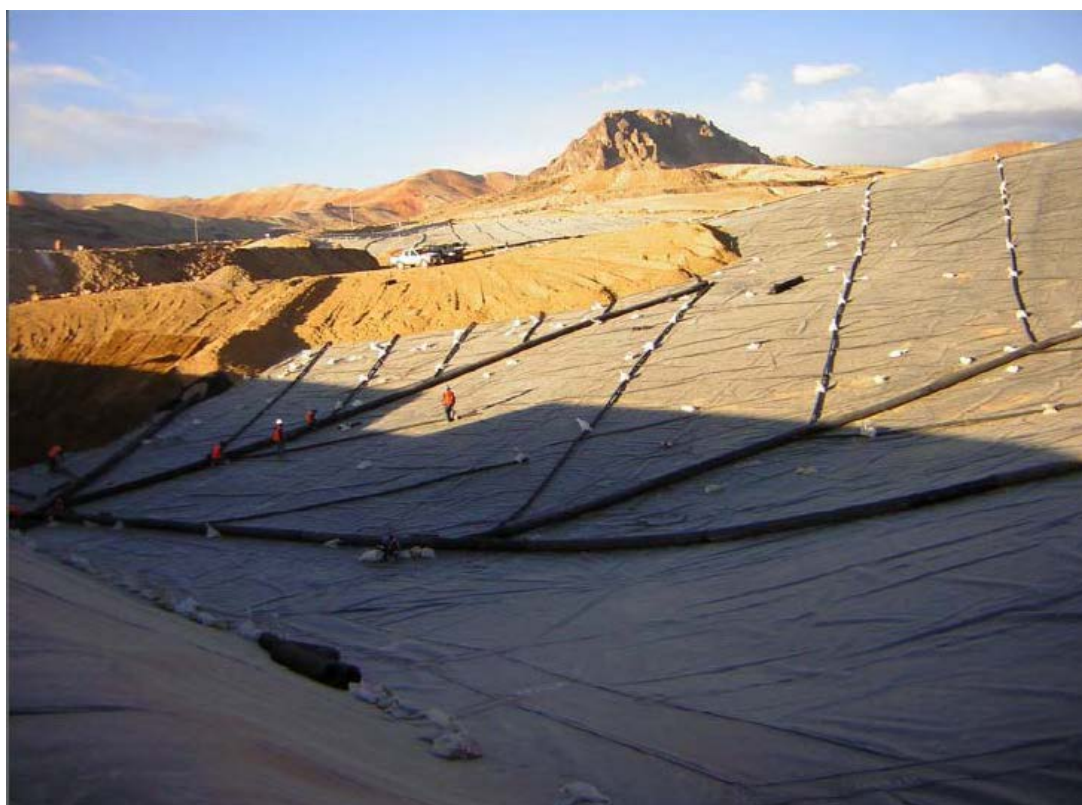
Colocación e instalación de las tuberías de colección, además de la colocación del overliner.
